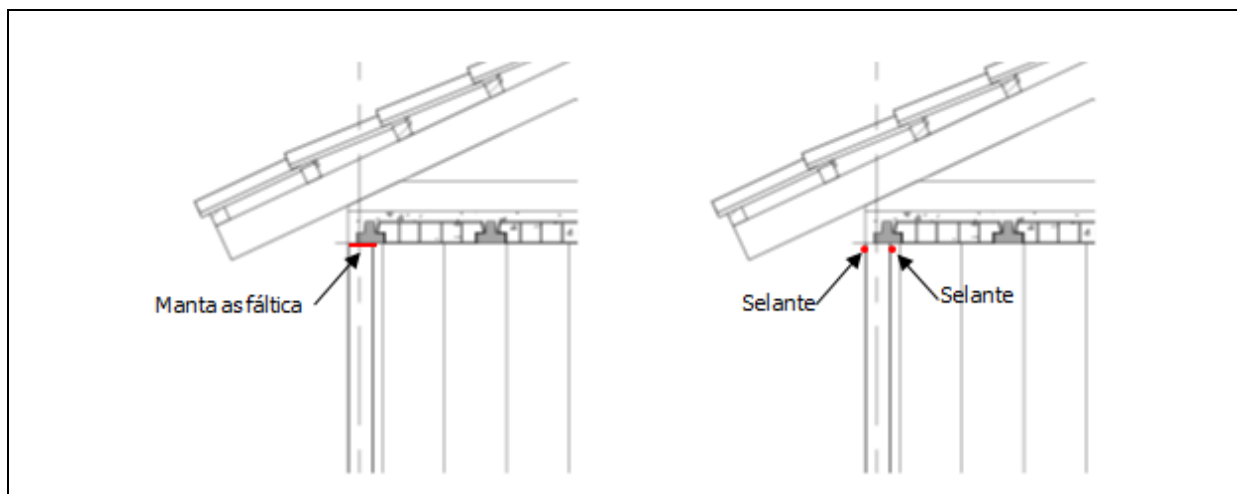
Ilustração da interface entre parede *Concreto-PVC* e laje de concreto. (Sem escala).
